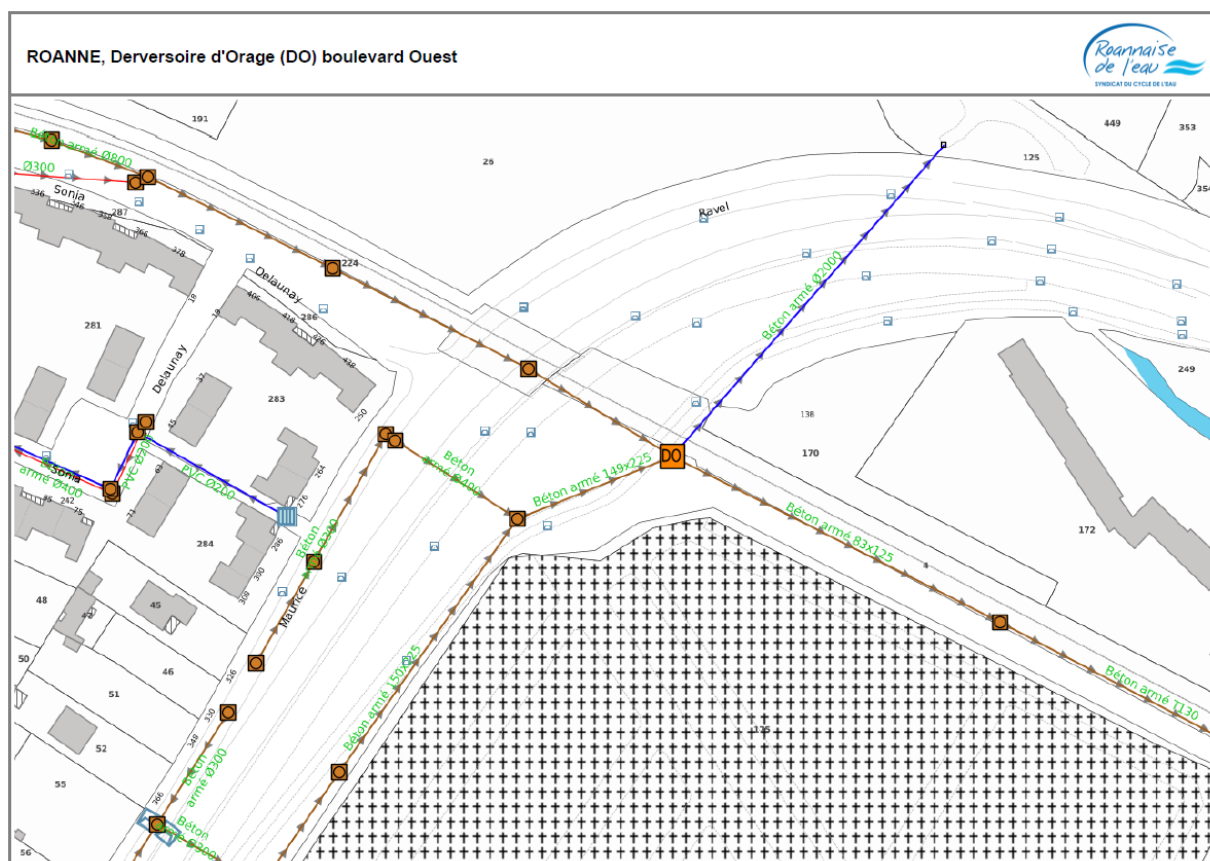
Plan présentant la situation du déversoir d'orage du boulevard Ouest
